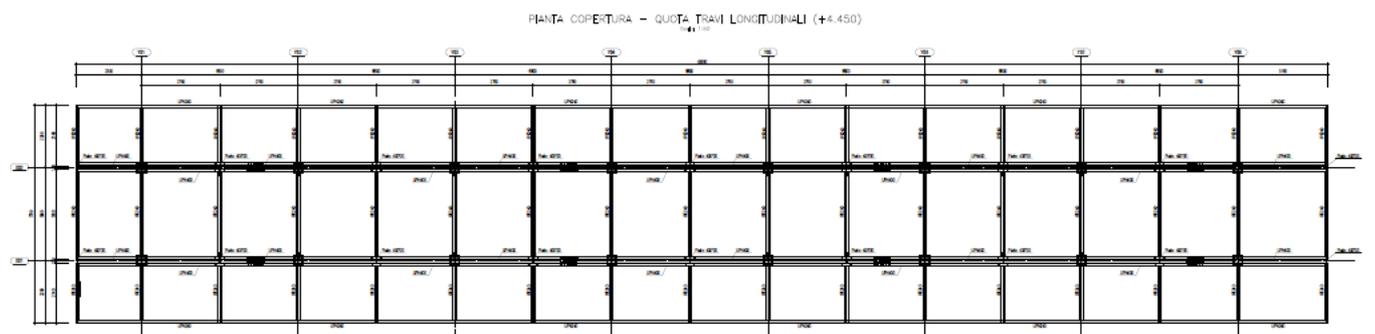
Pensiline – Pianta Copertura quota +4.450 - Pensilina Nord
